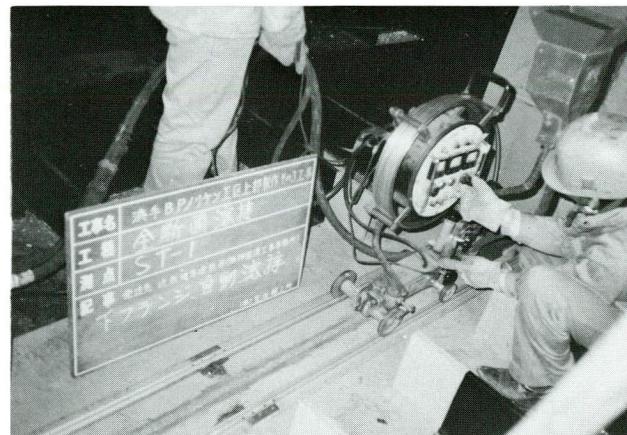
下フランジ中央部潜弧片面自動溶接
